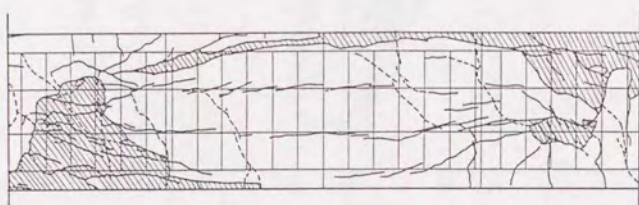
ひび割れ状況（試験体 B6）
